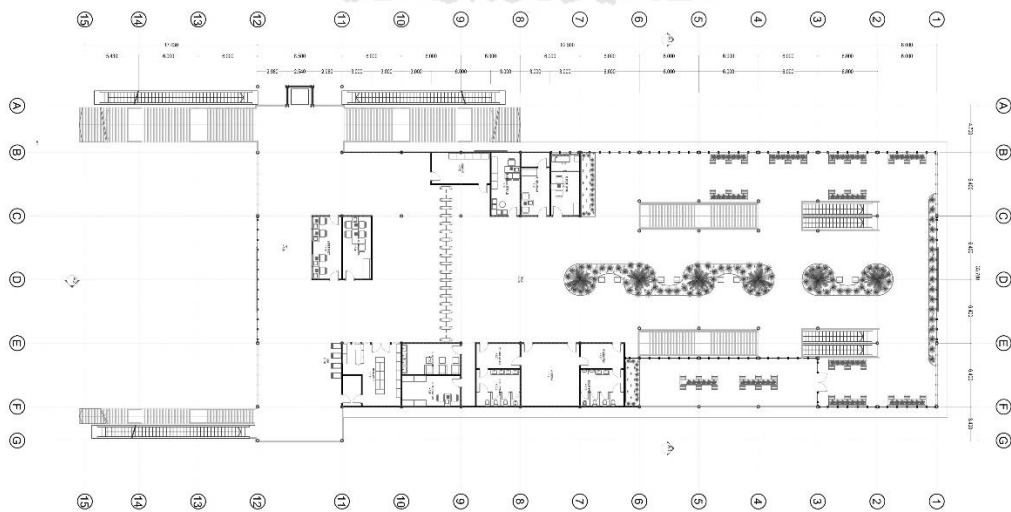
Siteplan Rancangan Stasiun Sentolo
